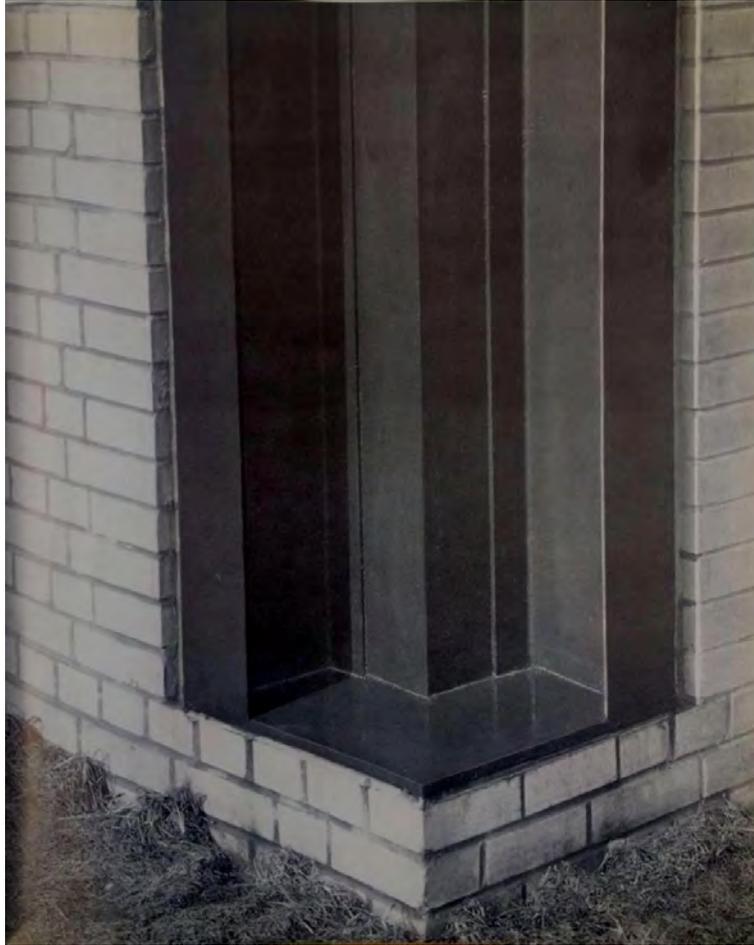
Banham, R. IIT, detalle de columna de acero, Mies Van Der rohe. (Fotografía). Fuente: El Brutalismo en Arquitectura Consultado el 11/11/17
